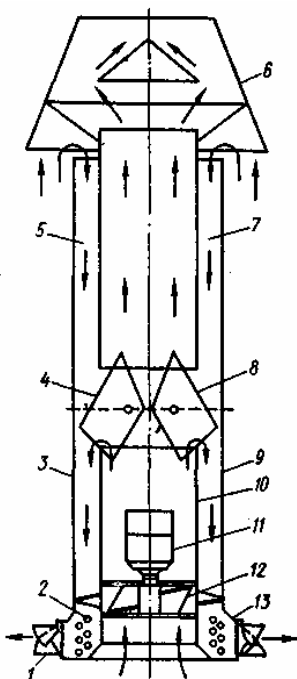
Схема приточно-витяжної установки: 1 – шарнірний відбивач; 2, 13 – нагрівальні елементи ТЕН-26 і ТЕН-27; 3 – циліндричний кожух; 4, 8 – заслінки поворотні напівциліндричні; 5, 7, 9 – кільцеві проточні
